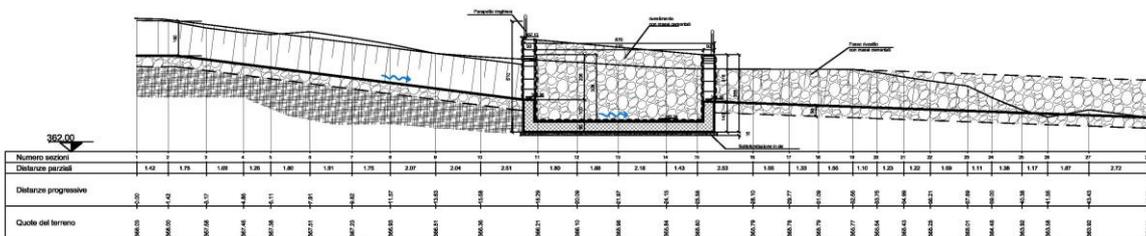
Compluvio nord – Vasca di sedimentazione - sezione
